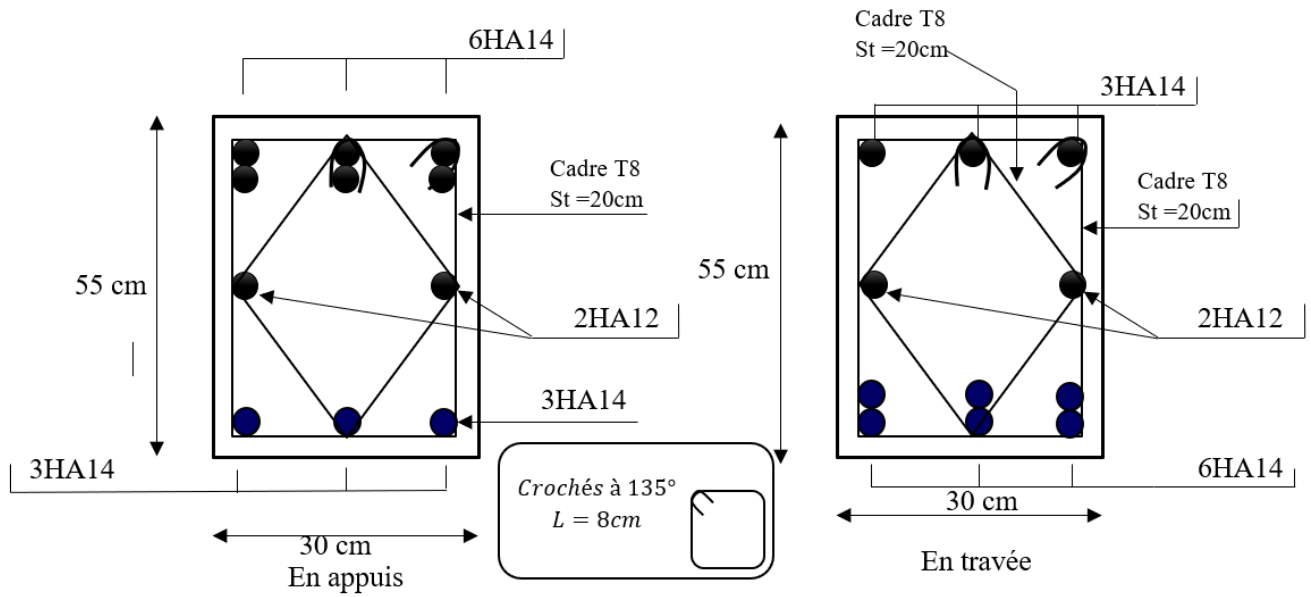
Schéma de ferrailage de la poutre palière.
